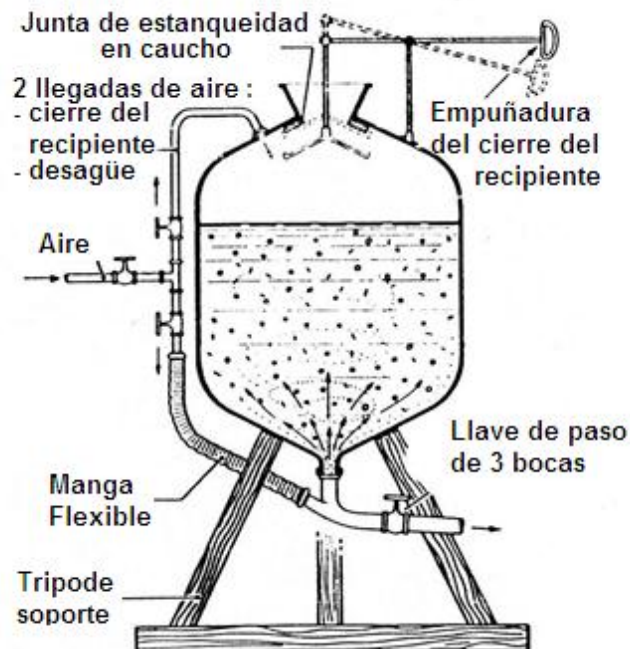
Aparato tipo Johnny (Cambefort, 1968)
